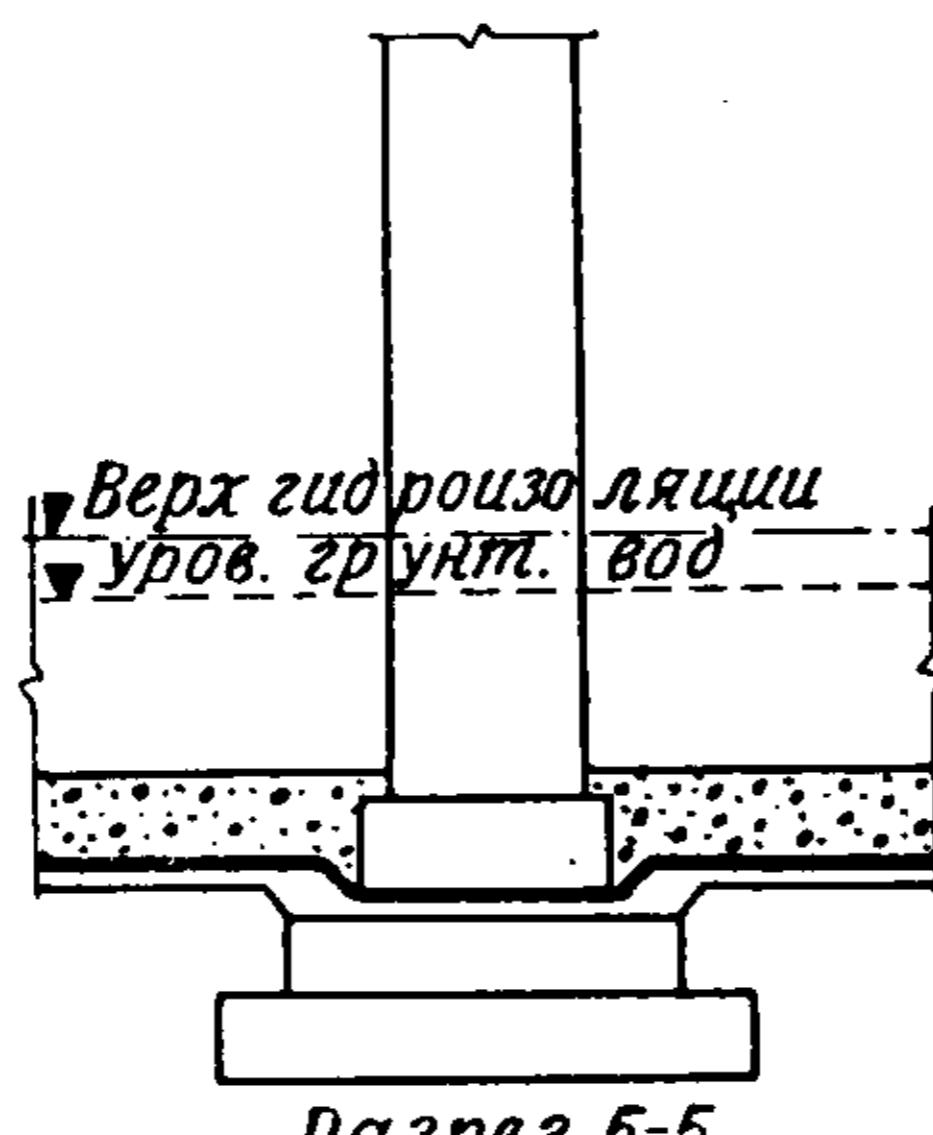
Вариант 1. Изоляция у трубы. Боров поднят над изоляцией. Рекомендуется
